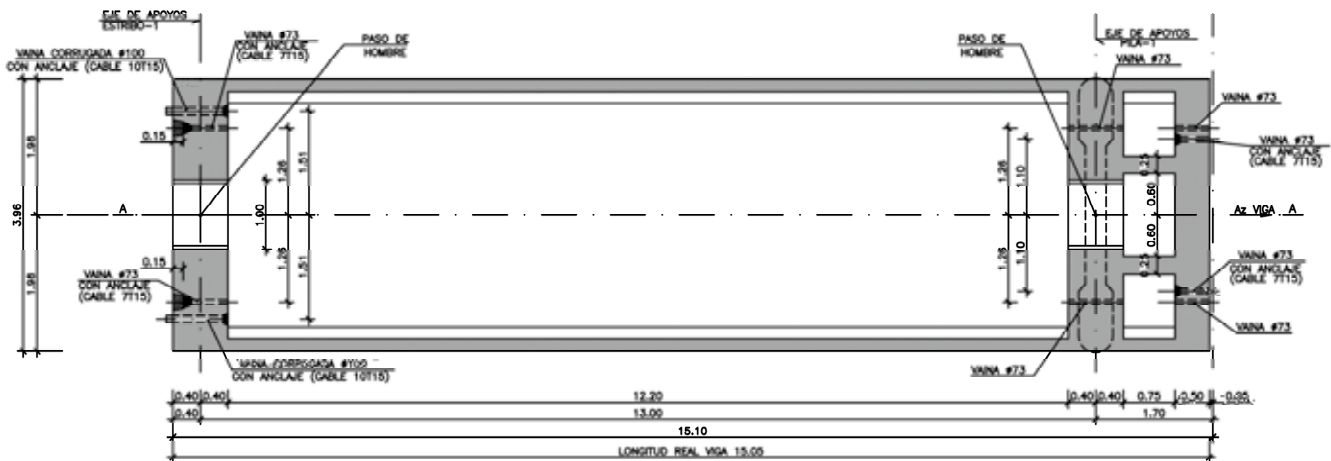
Planta de la viga prefabricada del vano 1 (de 13 metros de luz).
